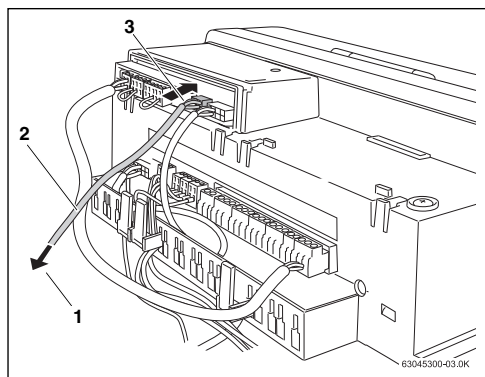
Fühler für Kesselwassertemperatur/STB anschließen
